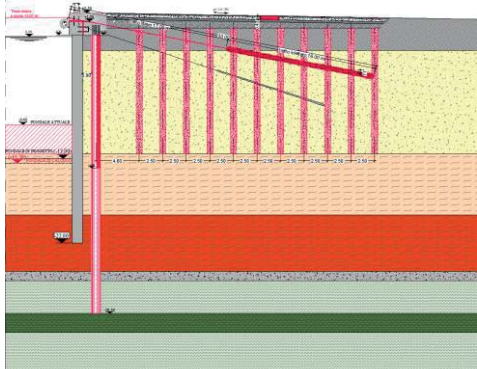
Stralcio planimetria di progetto - Banchina IFA
